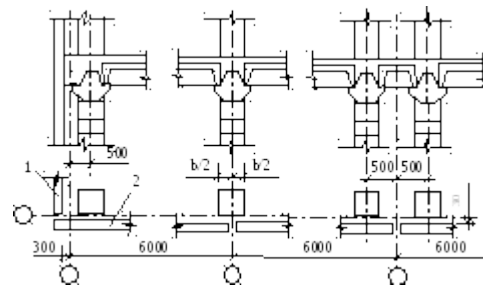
Привязка колонн и наружных стен многоэтажных промзданий с нормативными нагрузками на перекрытия 10...25 кН/м² к продольным и поперечным разбивочным осям и в местах температурных швов. 1 – торцовая стена; 2 – продольная стена.
